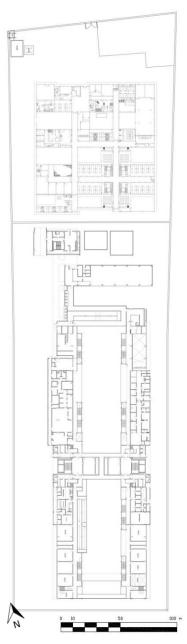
Planta primer piso EPMSC IPIALES Fuente: elaboración propia
